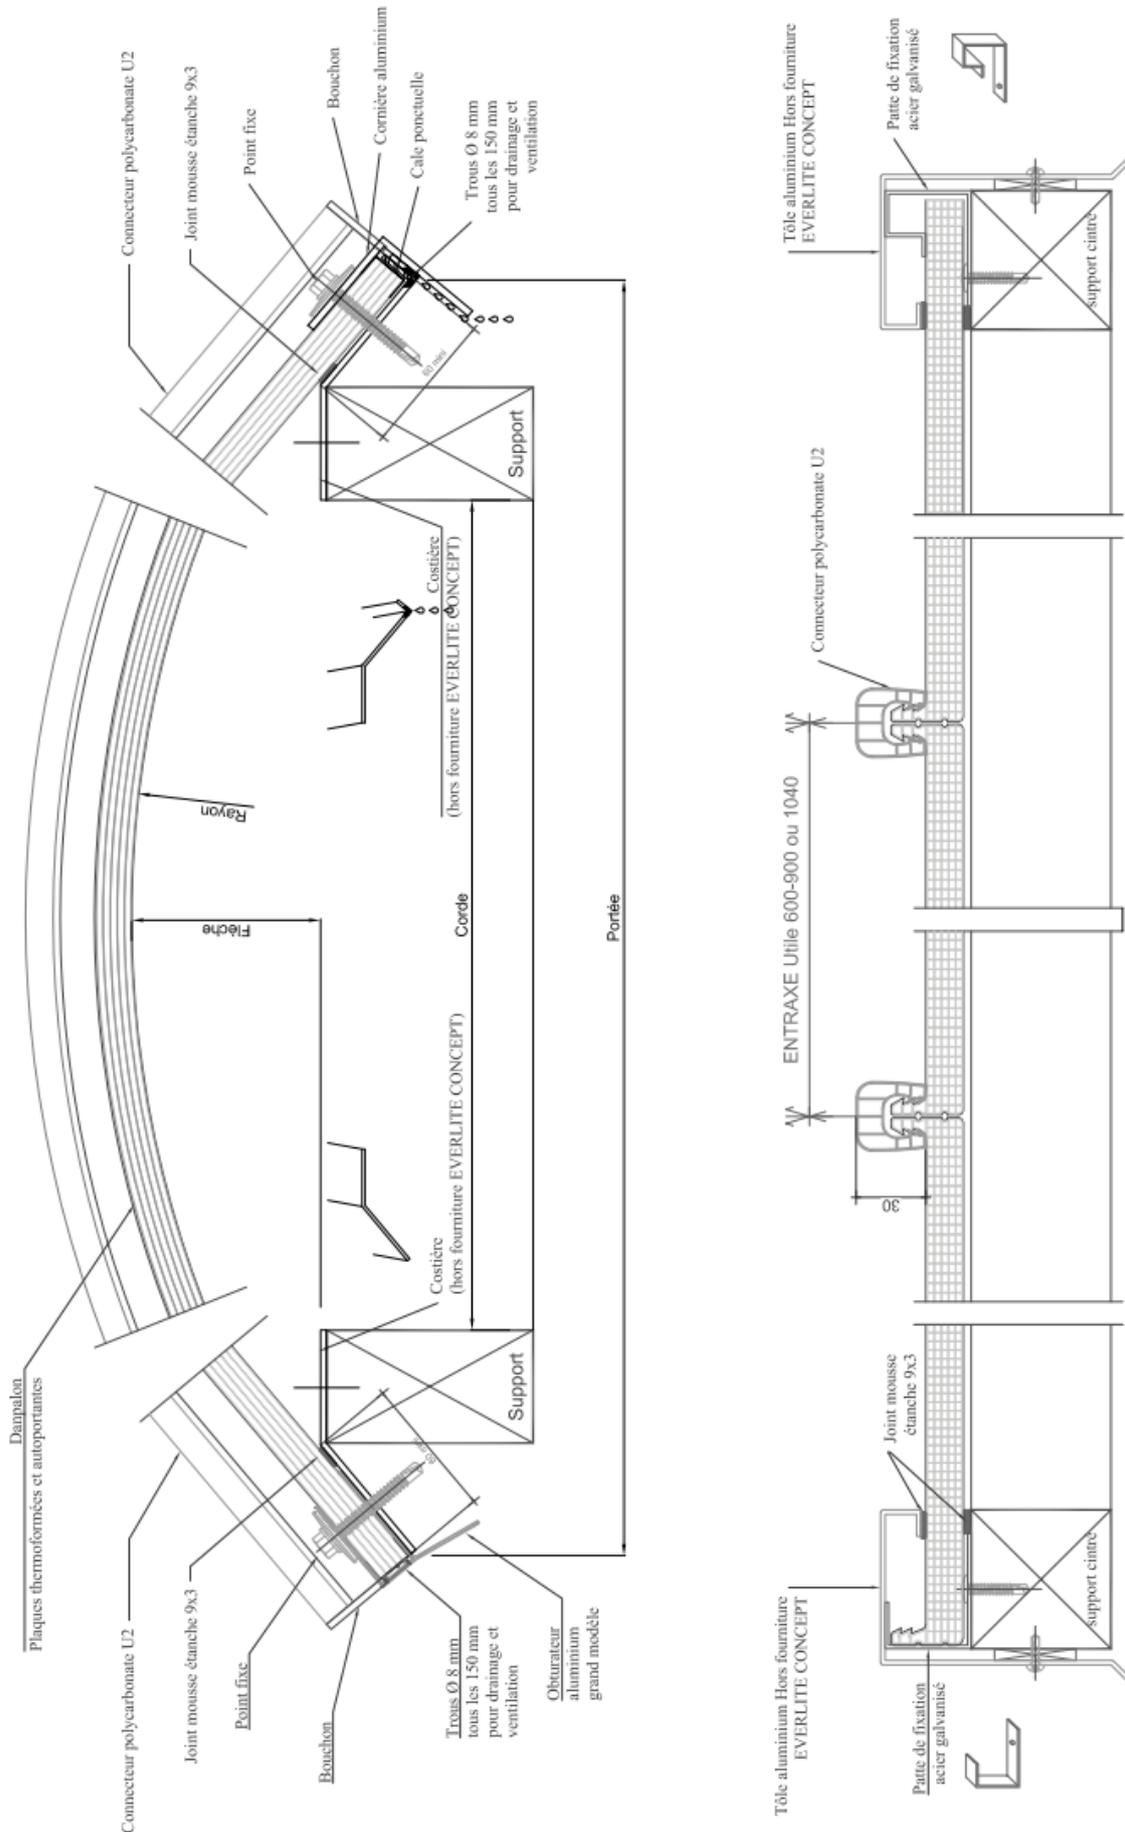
Coupes longitudinale et transversale sur connecteur polycarbonate – Système DANPAVOUTE
